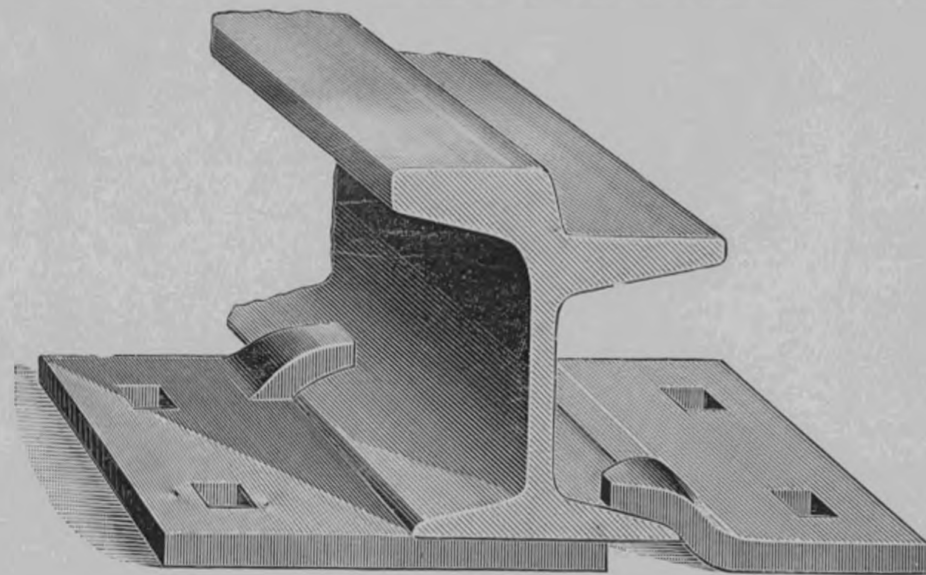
RAIL DE TRAMWAY A SELLE D'ATTACHE SUR LES TRAVERSES POUR POSE DANS UNE CHAUSSEE ORDINAIRE
